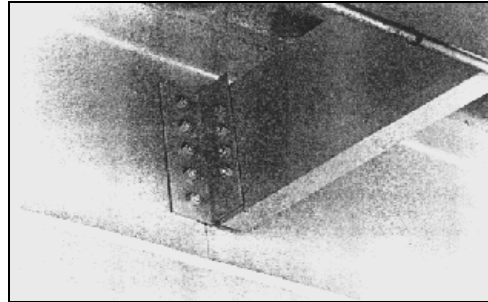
Cornière d'assemblage entretoise – poutre par boulons (d'après [11])
